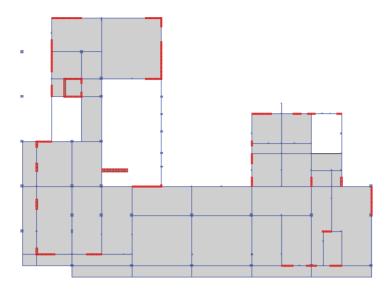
Planta primer piso, Liceo Politécnico Pitrufquén.
